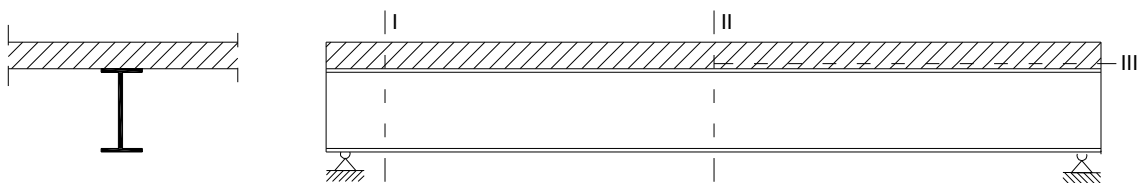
Trave d'acciaio con soletta collaborante
